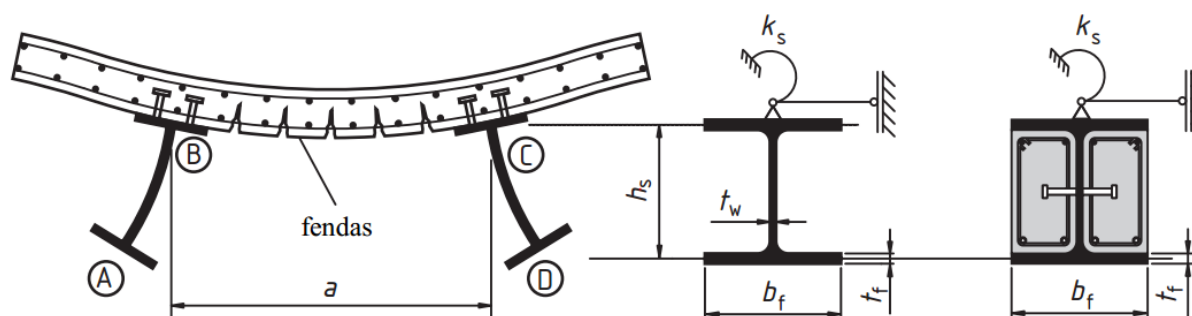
Efeito *U-Frame* em vigas mistas (adaptado de CEN, 2011).
